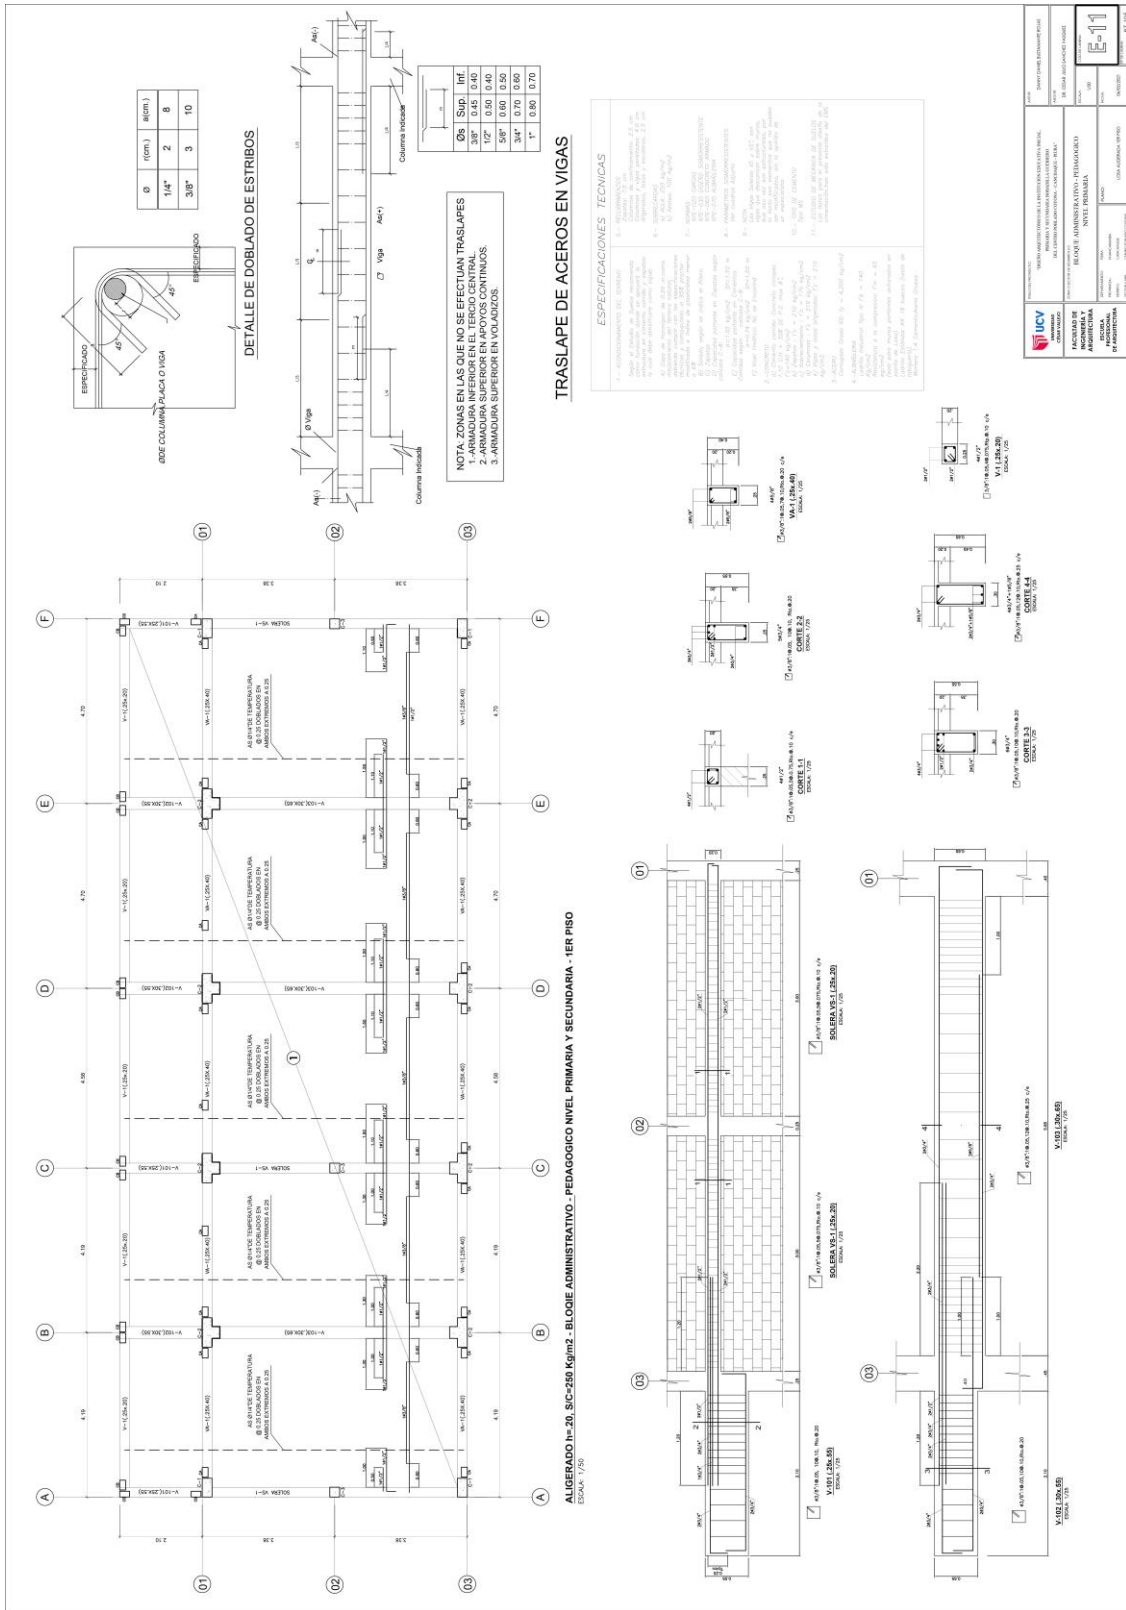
PLANO DE LOSA AULAS NIVEL PRIMARIA 1ER PISO
